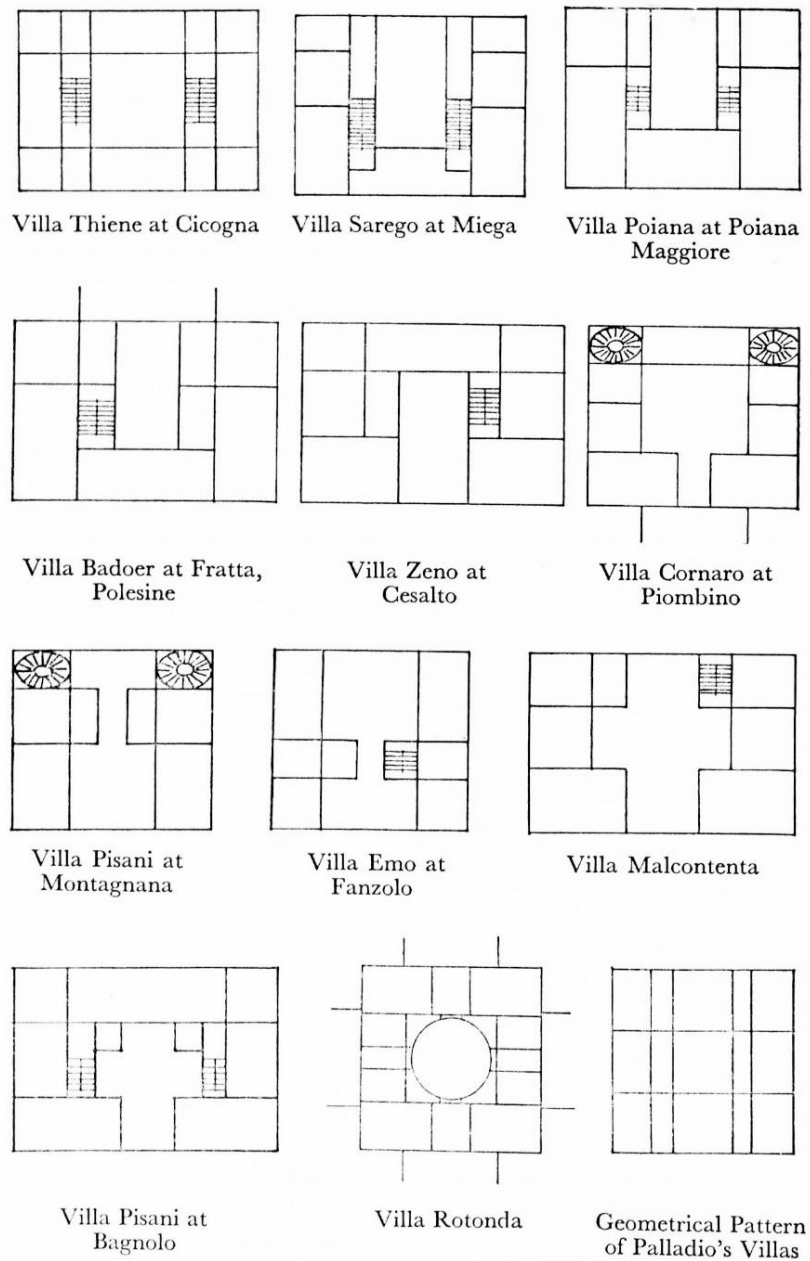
Andrea Palladio: Grundrisschemen, Villentypen, Italien, 16. Jahrhundert
